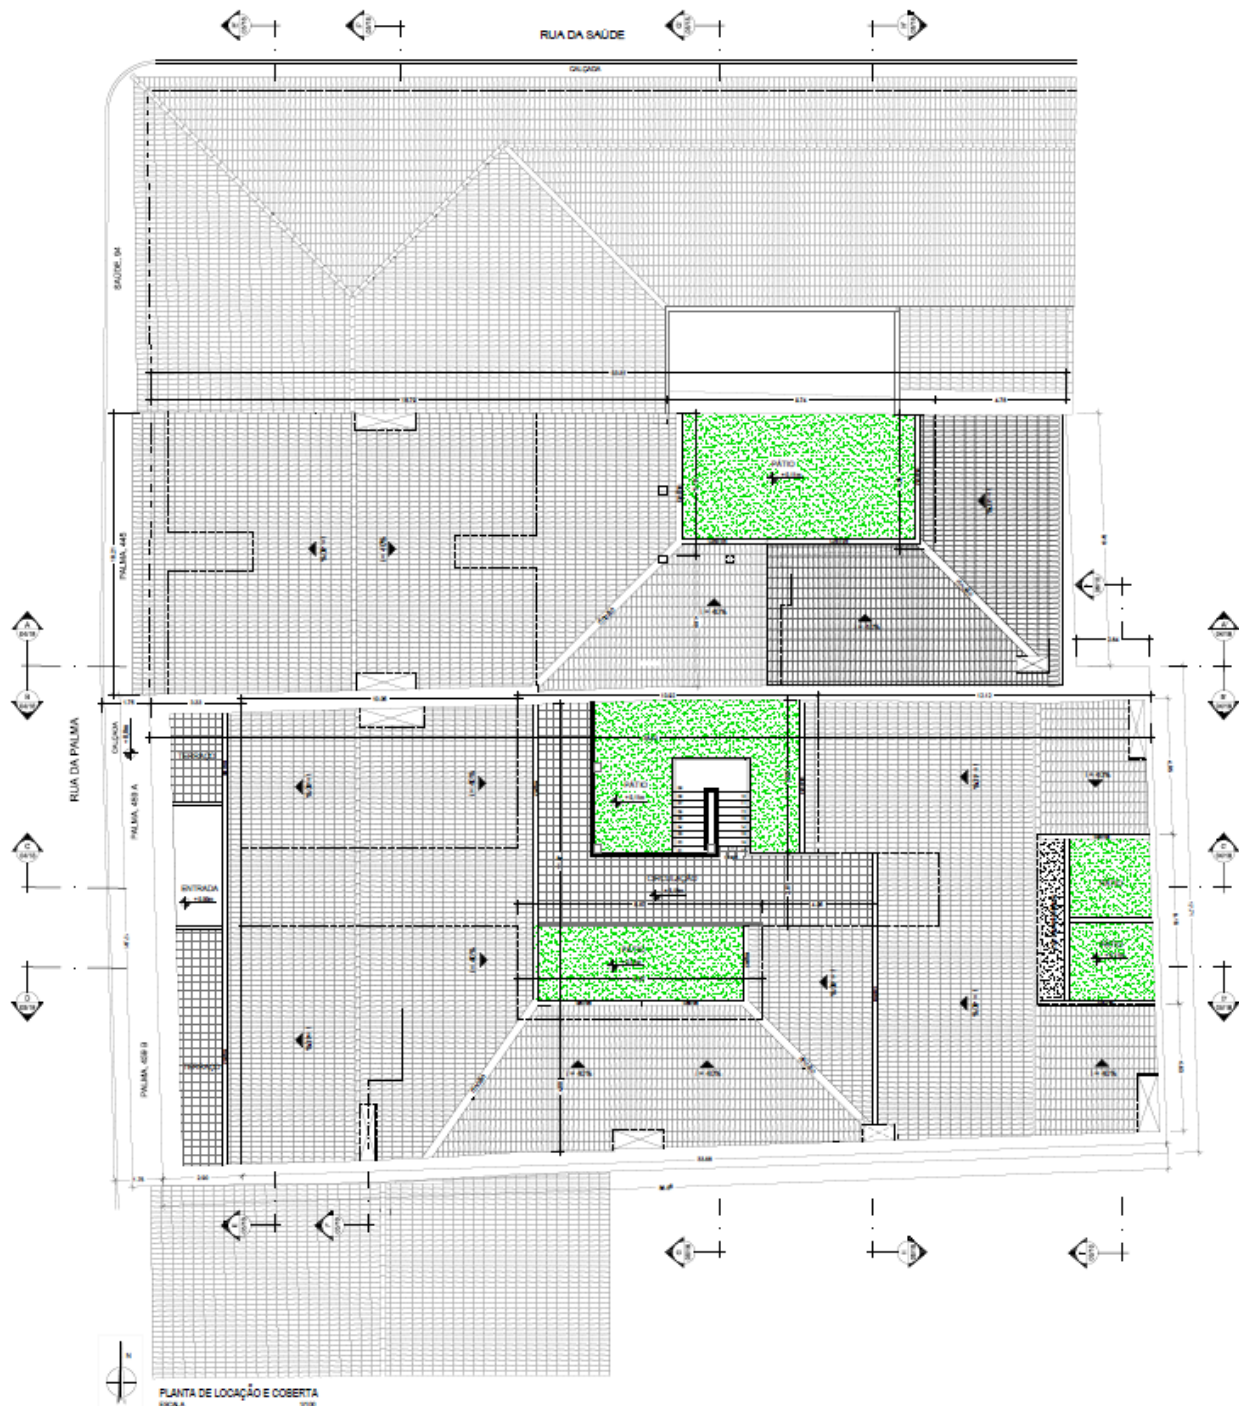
Proposta de intervenção - Implantação - Rua Palma.
